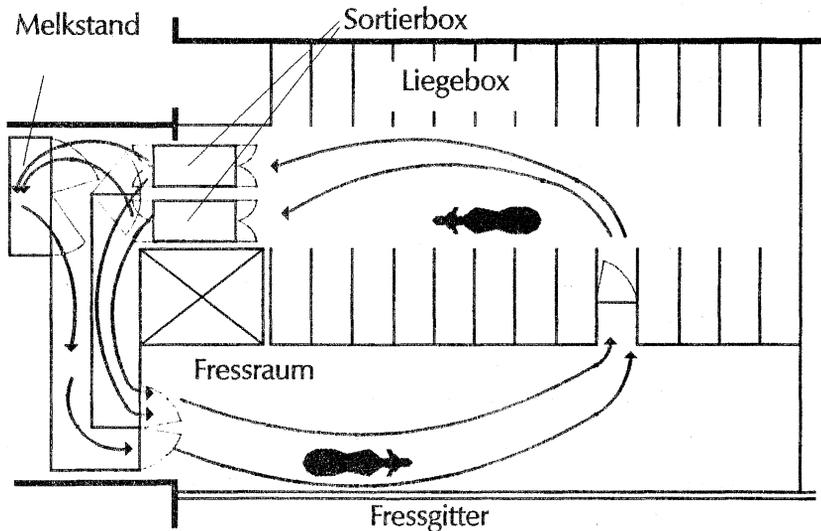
Grundriß eines Stalles mit einer automatisierten Melkanlage
